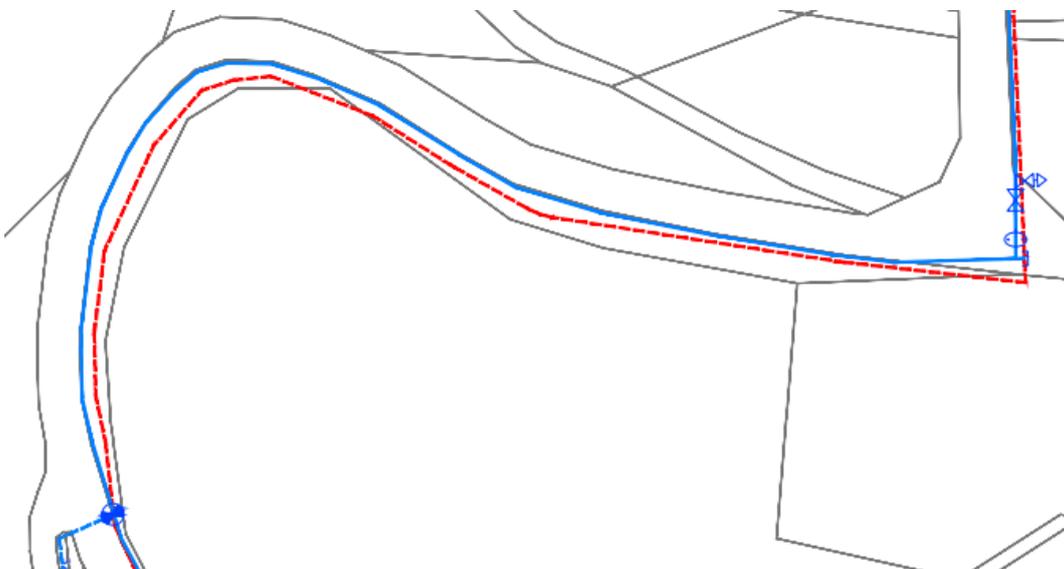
Rilevo planimetrico dei sottoservizi (in rosso rete gas, in blu rete idrica)
